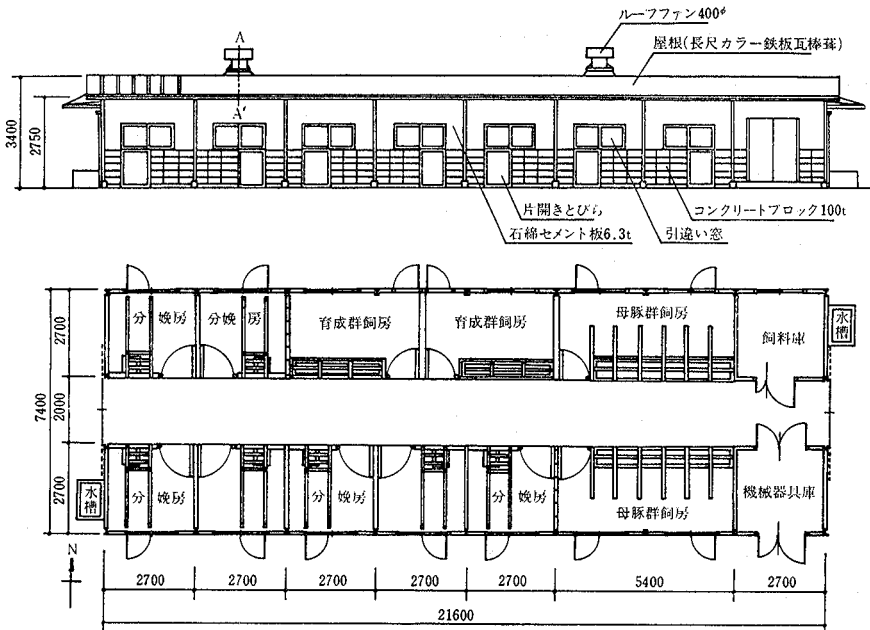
切妻屋根式繁殖豚舎の立面図（南面）と平面図
